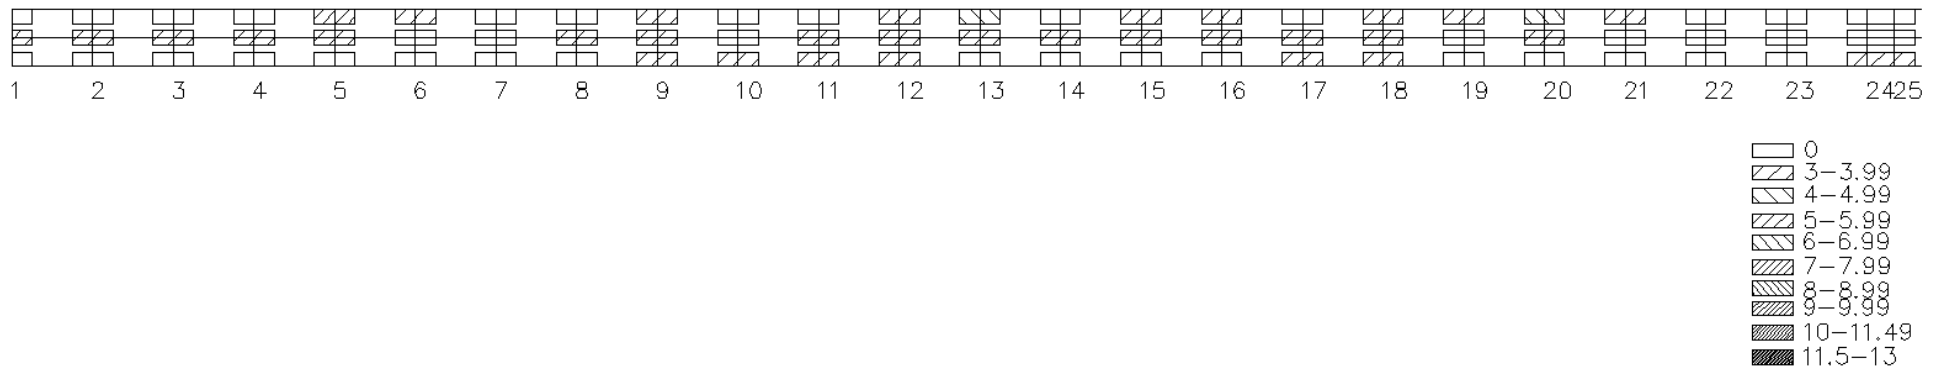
Ausgleichungsdicke bei kubischer Splinefunktion und Verfahrensplan Typ V, Grundriss, Stationen 1-25
